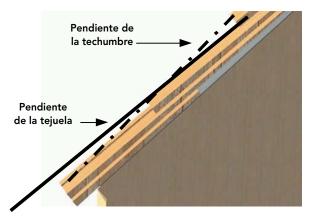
14: La techumbre pierde pendiente luego de colocar la tejuela.
